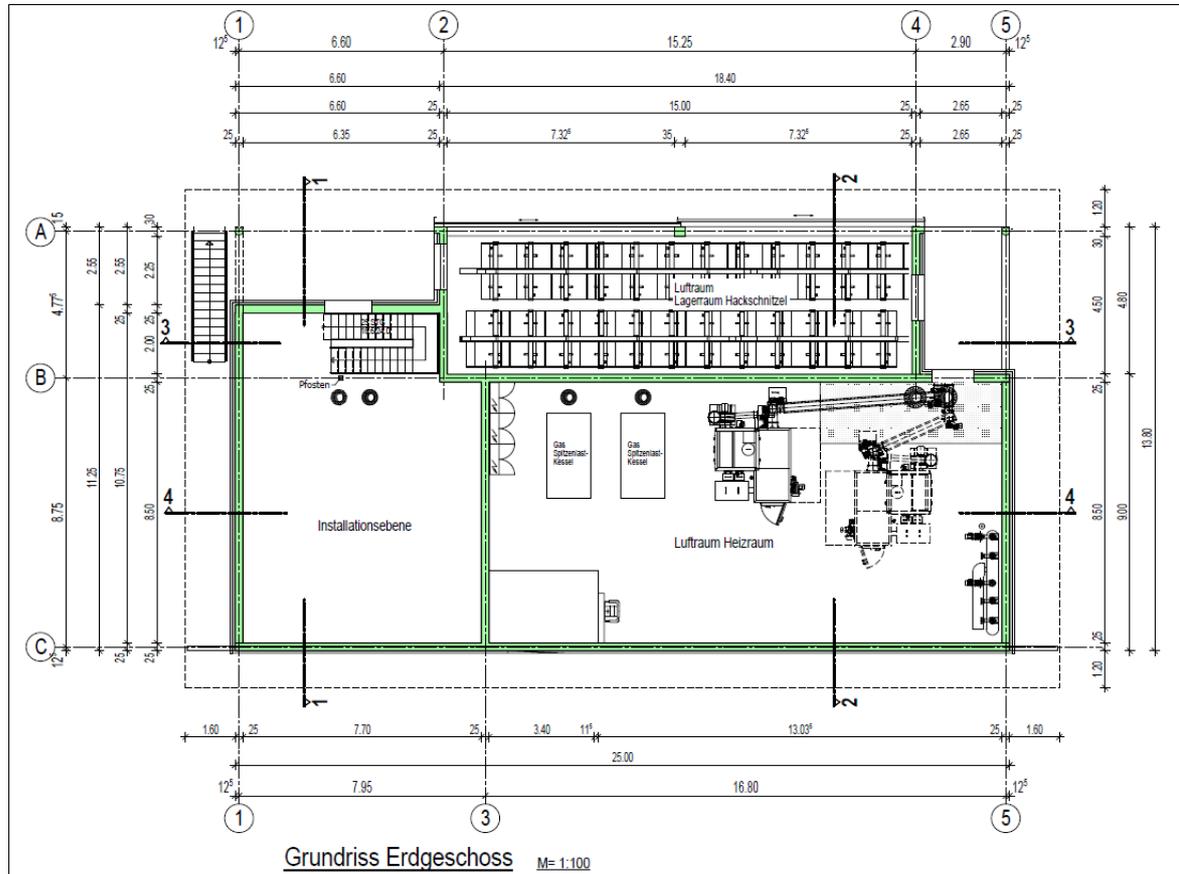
Grundriss EG der Heizzentrale (die im Plan dargestellten Gaskessel wurden nicht ausgeführt, stattdessen ein Ölkessel).
